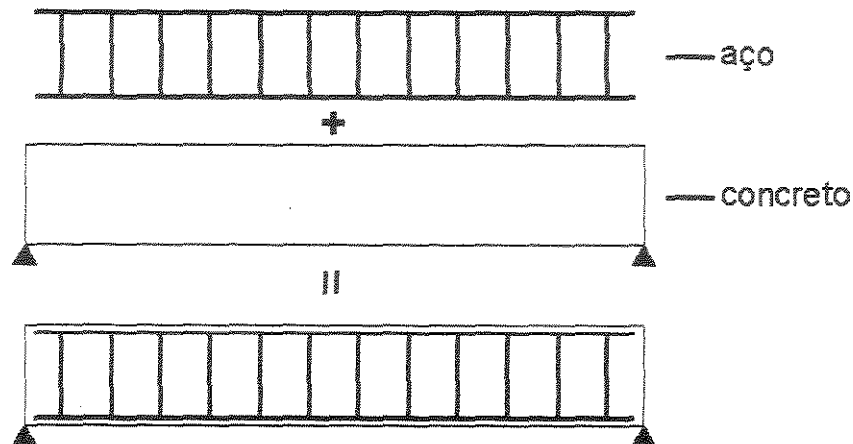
Representação da viga desmembrada - armadura e concreto.
